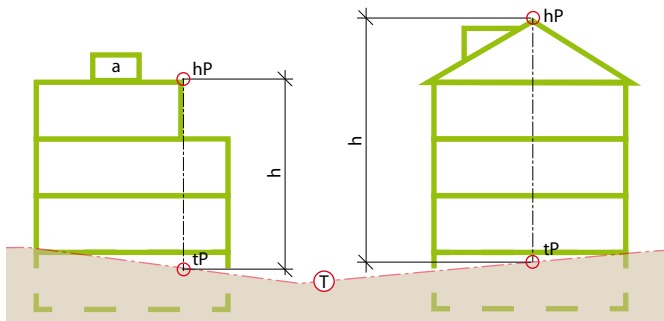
Gebäudegeometrie; T = massgebendes Terrain, h = Gesamthöhe, tP = tiefster Punkt auf massgebendem Terrain unter der Dachfläche, hP = höchster Punkt der Dachkonstruktion, a = technisch bedingte Dachaufbaute (Skizze nach VKF)
